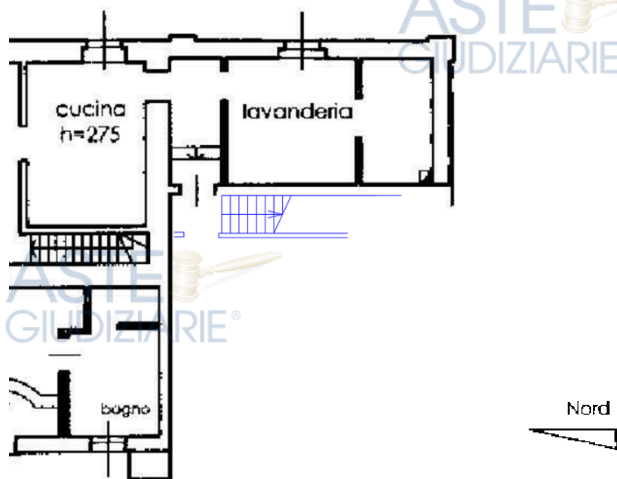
Stralcio della planimetria catastale del piano terra, con raffigurata la scala a rampa unica che conduce al primo piano
